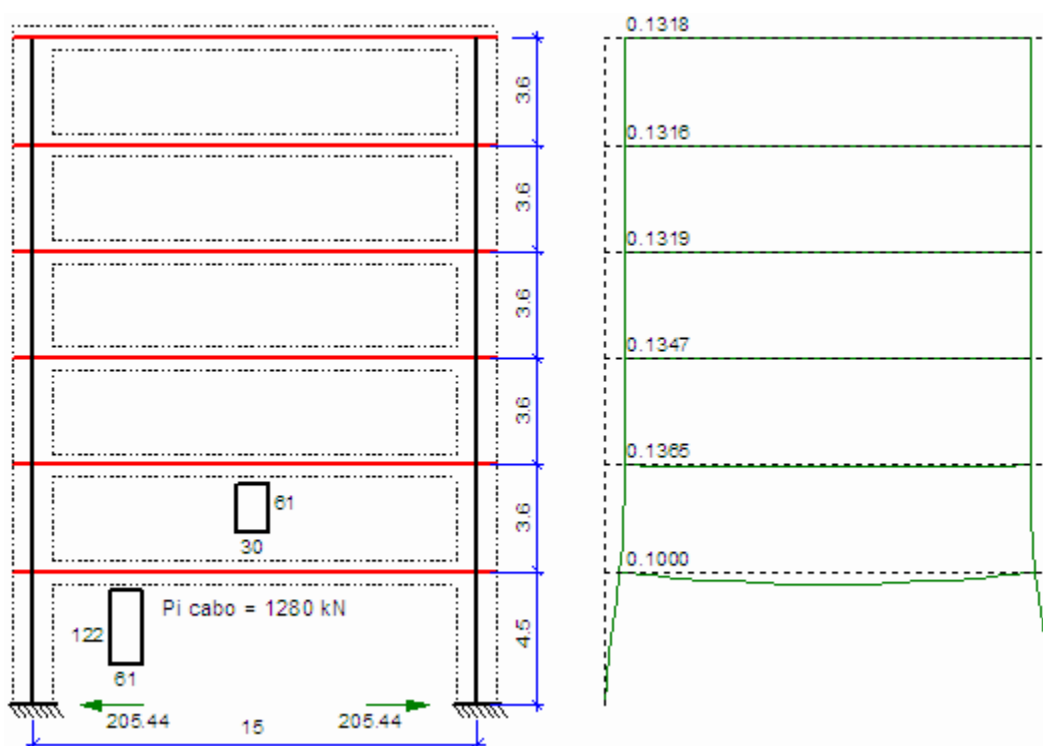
Pórtico com protensão em todos os pavimentos - Geometria e deslocamentos
